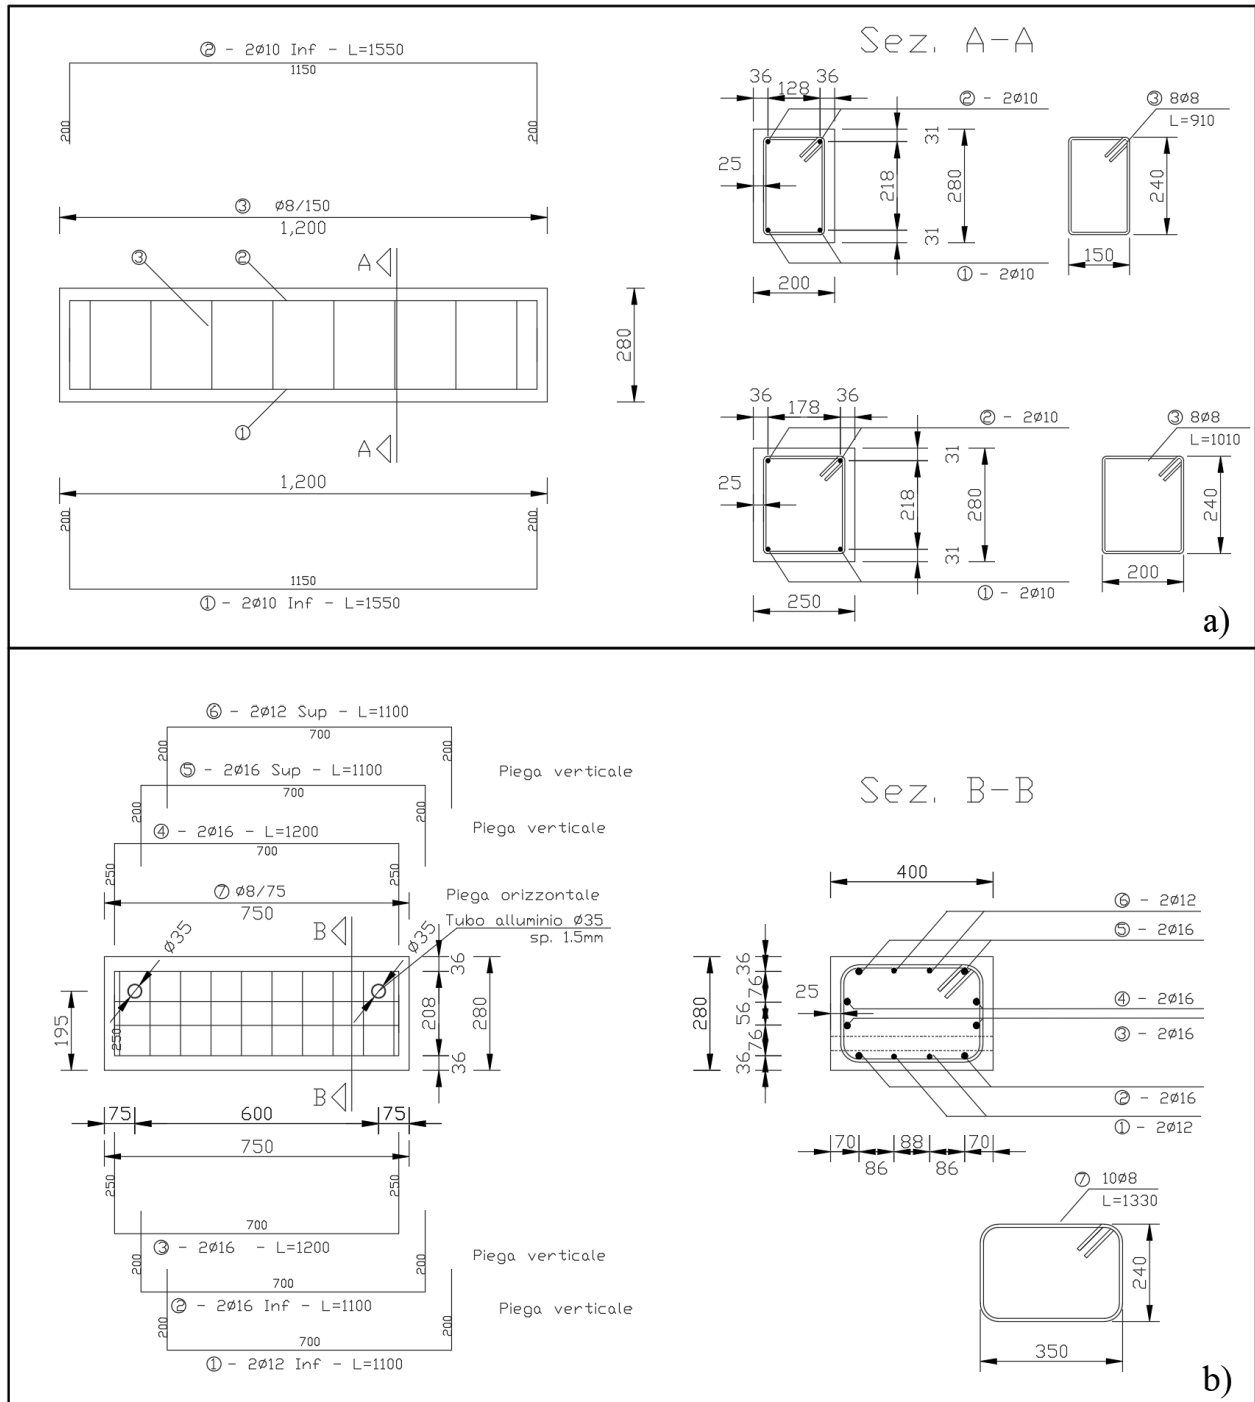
Prove di taglio parallelo: Particolari costruttivi dei provini di cls: Armatura dell'elemento di calcestruzzo debolmente armato ("cordolo") (a) e armatura dell'elemento di calcestruzzo fortemente armato ("traverso")(b)
